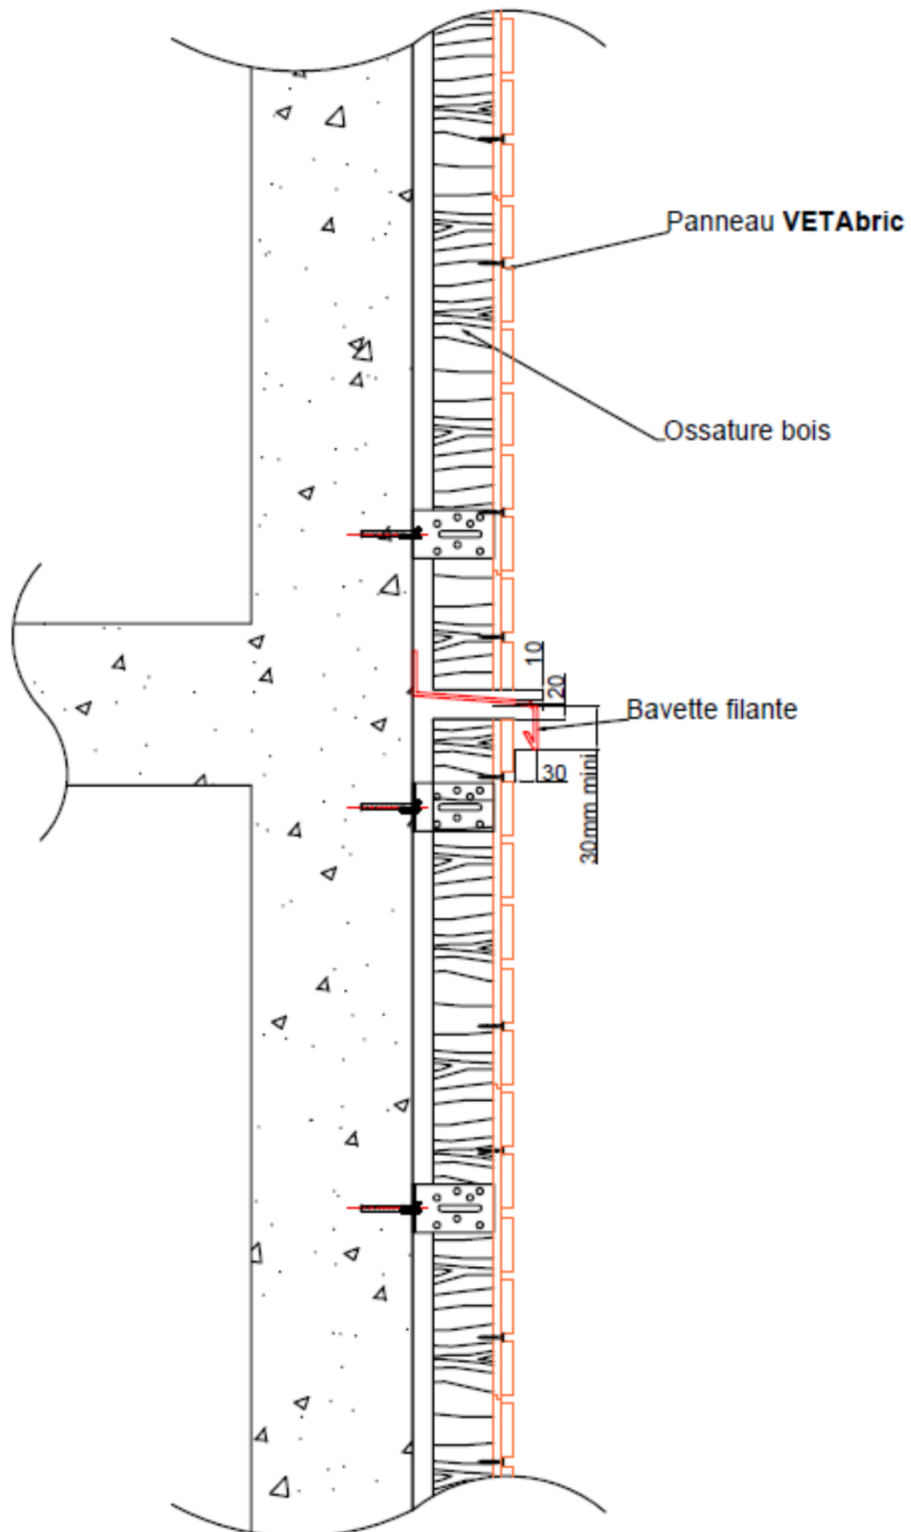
Fractionnement de l'ossature au droit de chaque plancher sur béton
